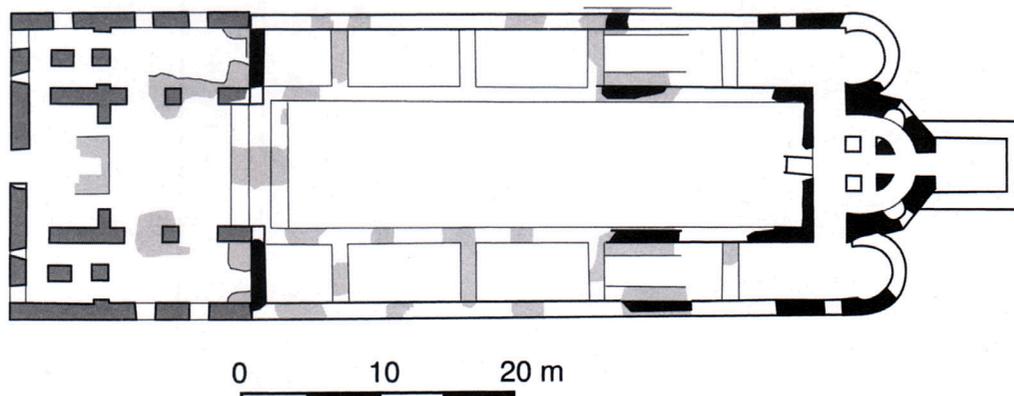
Werden, ehem. Klosterkirche St. Ludgerus. Grundriss nach 799 mit Bauphasen. Der Westbau entstand zwischen dem späten 9. Jahrhundert und 930/940.
